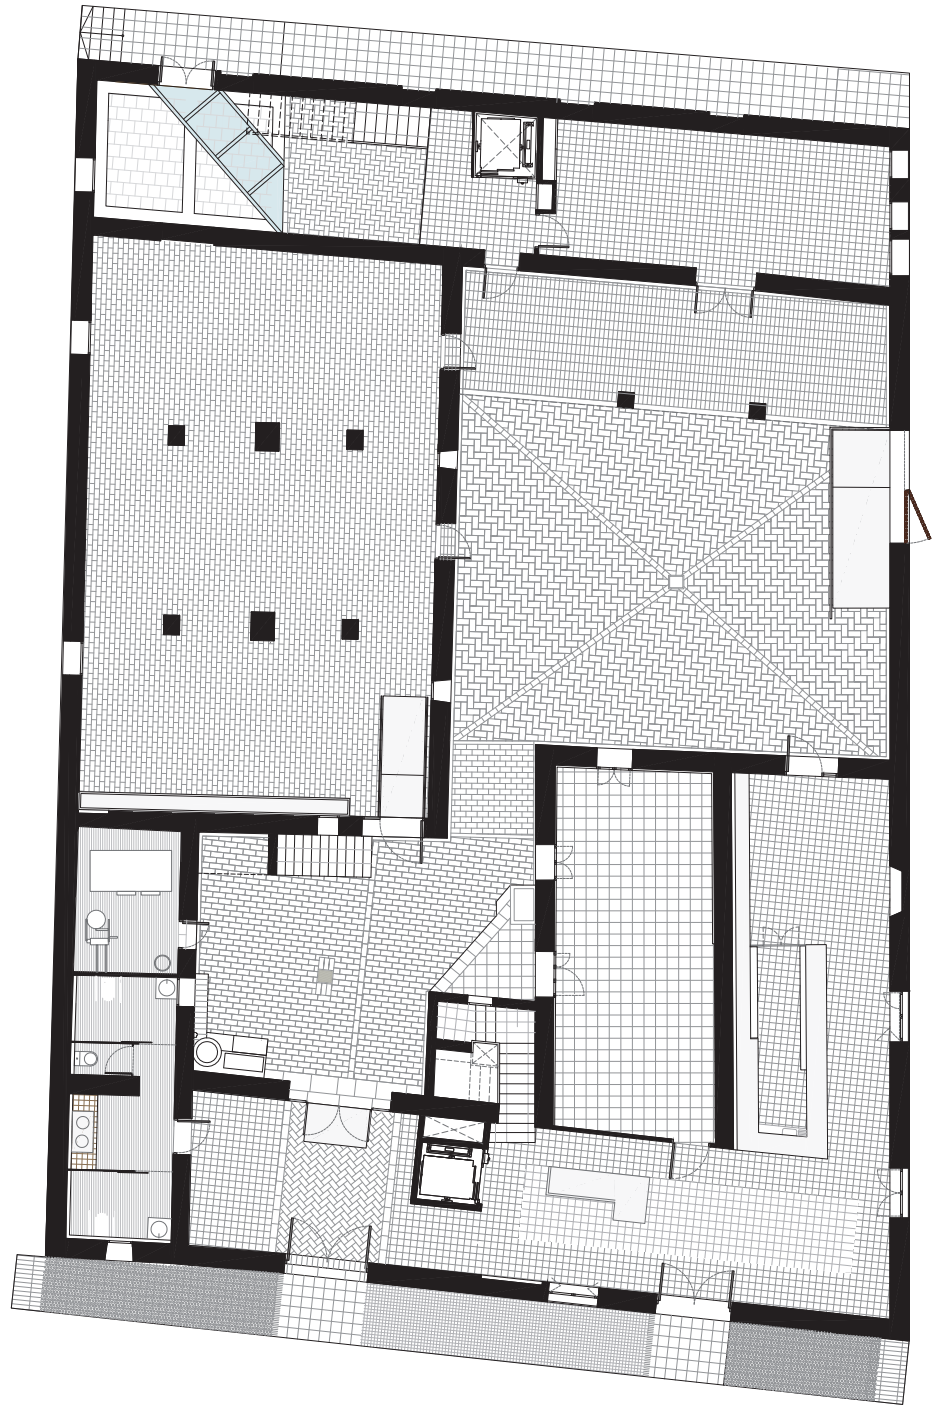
Planta baja (Javier Hidalgo, Arquitectura y Patrimonio)
